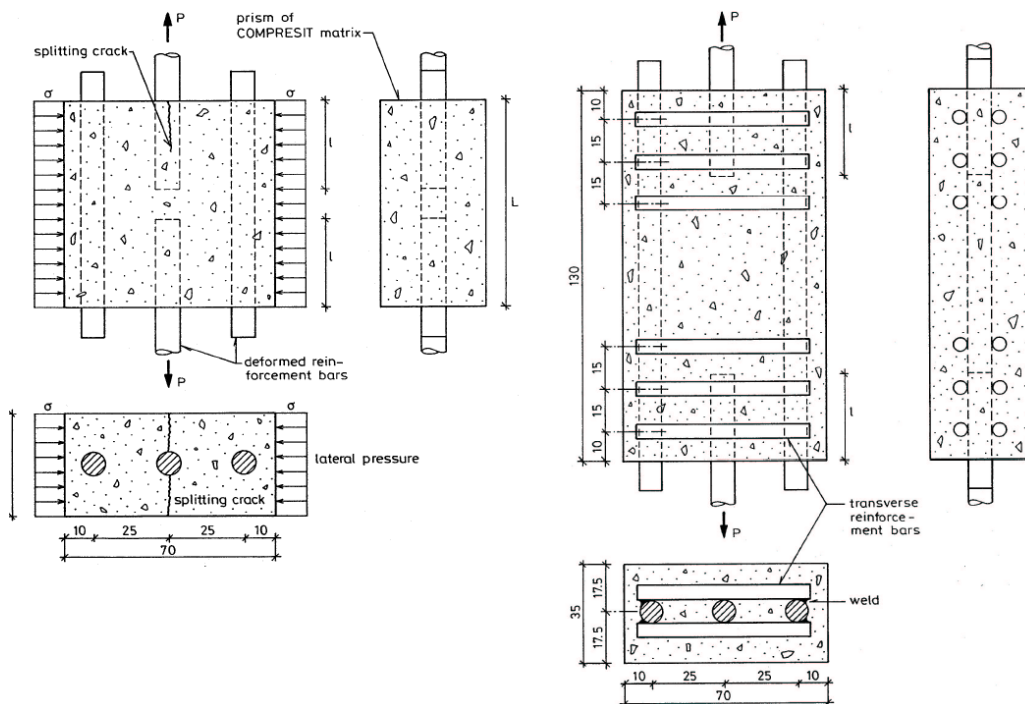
Schema vzorků a rozložení zkoušky dle [81,82]
